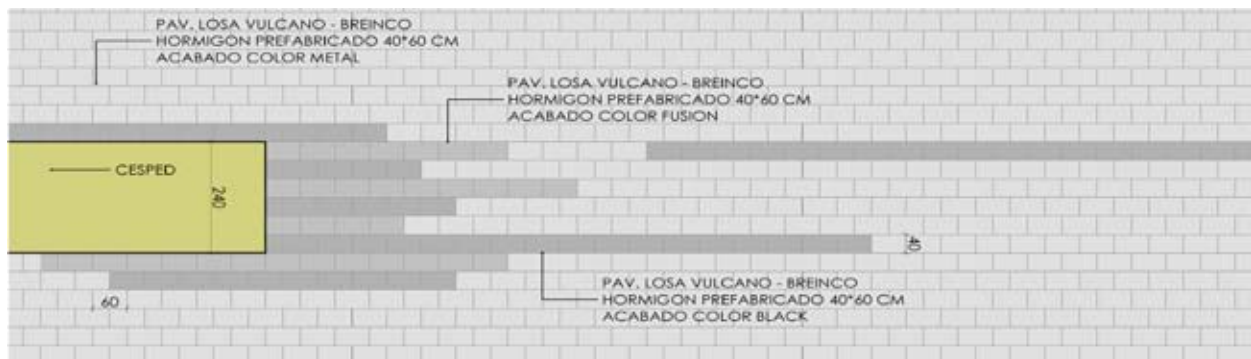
Detalle de la estereotomía de los pavimentos en la nueva plaza de la Formiga
